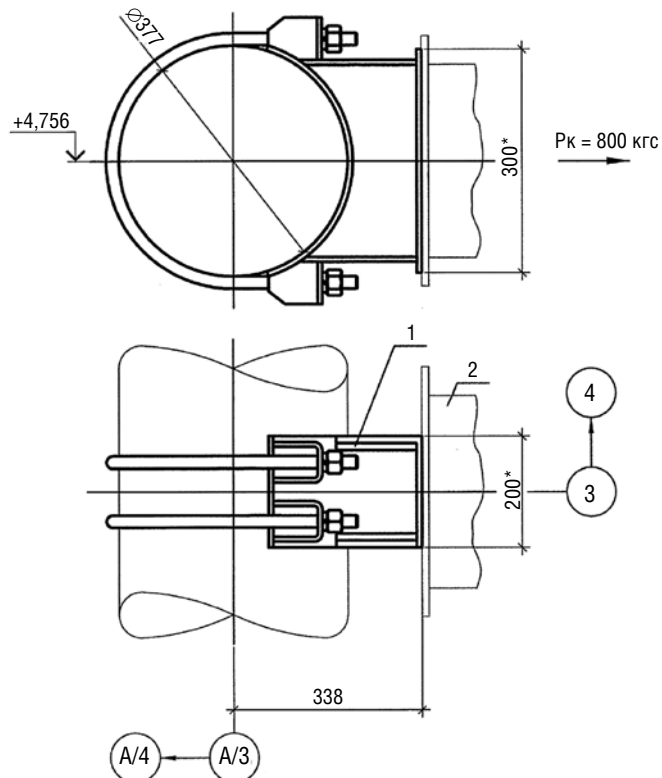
Ограничительная опора в одном направлении: 1 – стандартный корпус скользящей опоры; 2 – опорные металлоконструкции
